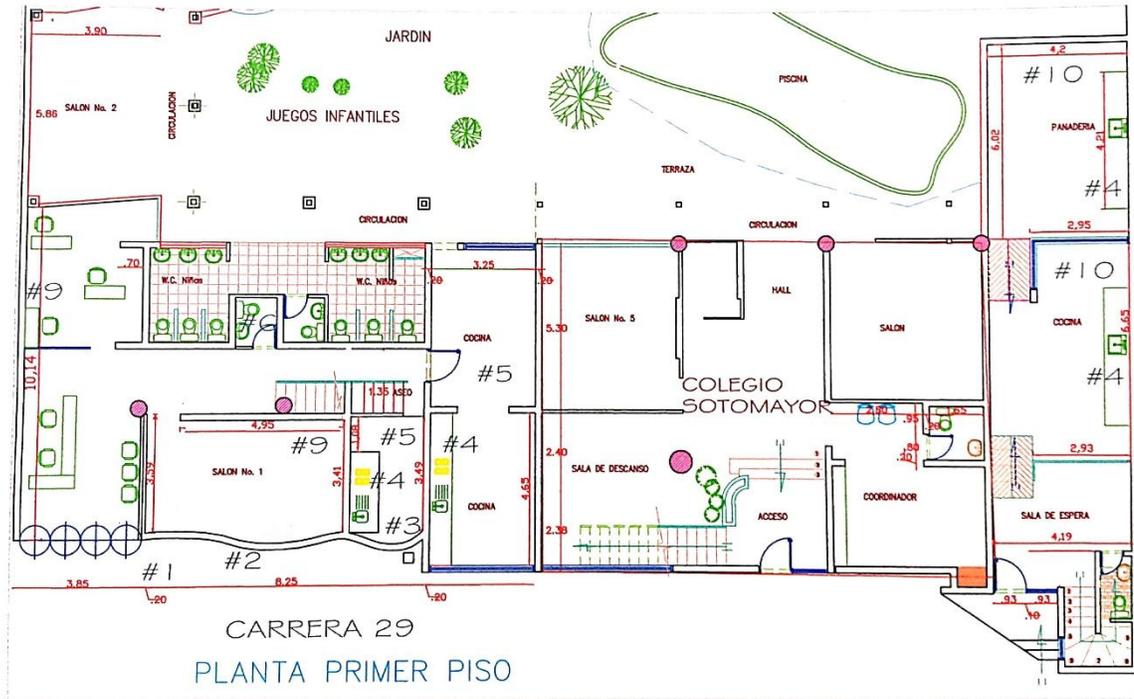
Plano arquitectónico primer nivel sede I.T.L.S.
